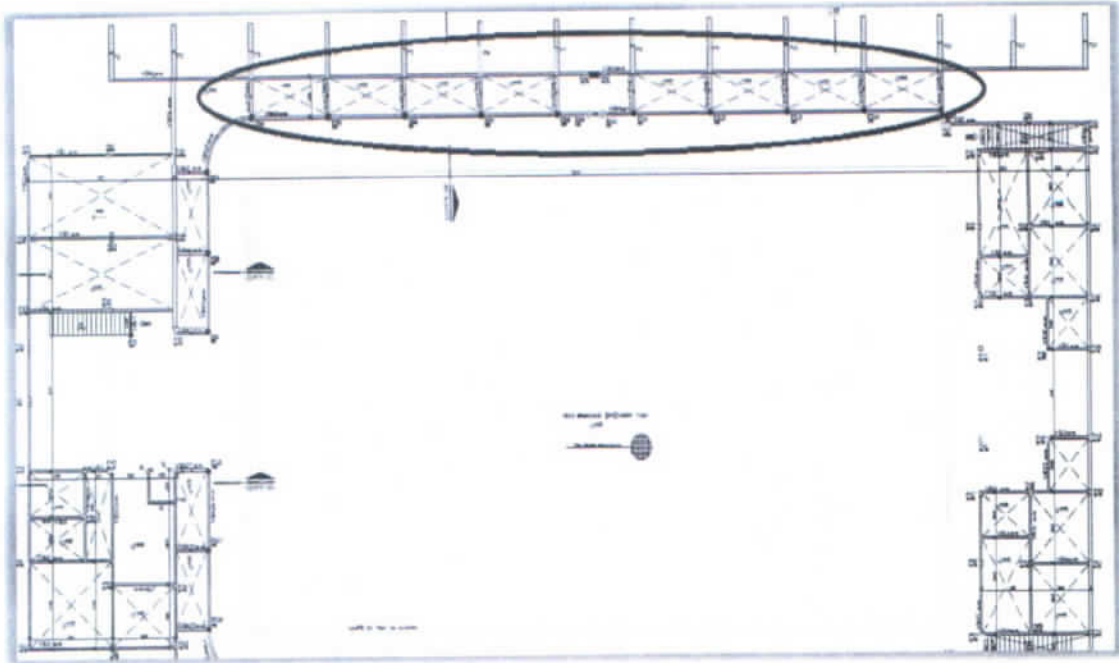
PLANTA DE FORMA DO CINTAMENTO
